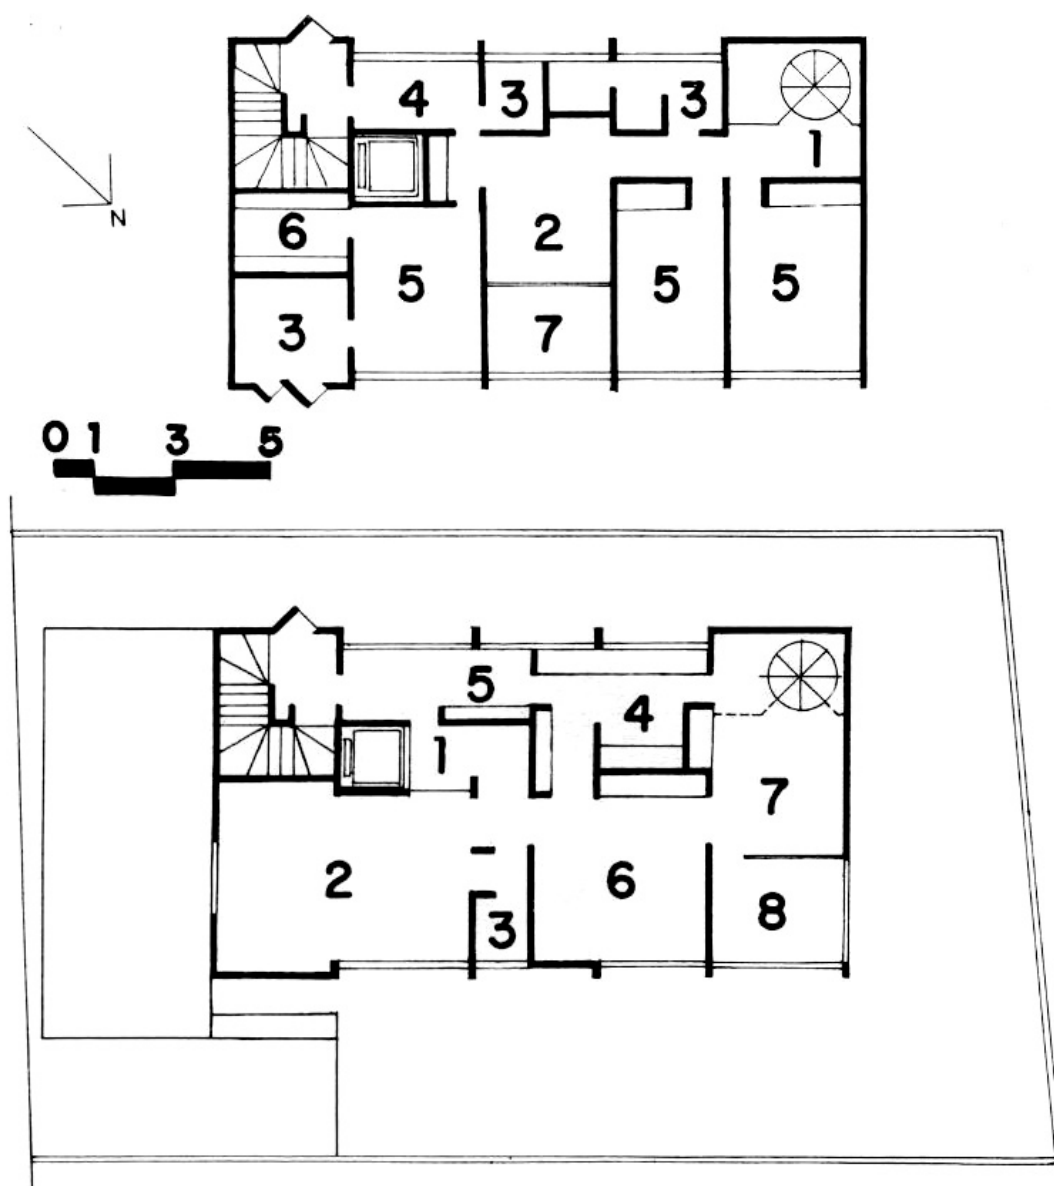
Edifício Camboatá (1980): planta pavimento superior: 1) hall; 2) atelier; 3) banheiro; 4) quarto de empregada; 5) dormitório; 6) vestir; 7) sacada.
